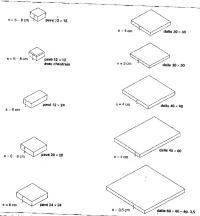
• Produits en basaltine - Pavés et dalles.
